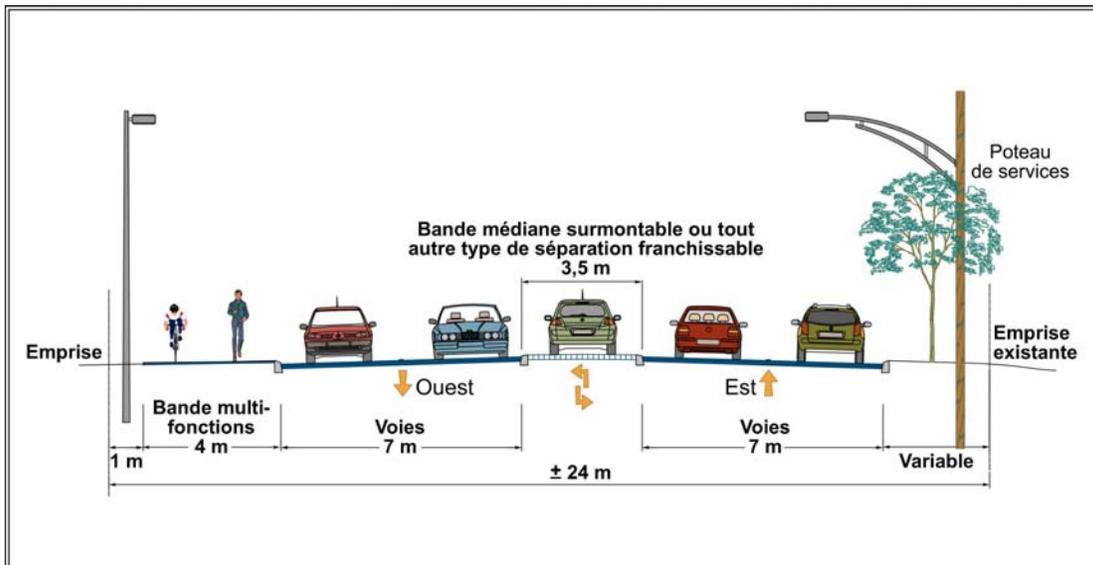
Coupe type du futur boulevard de la Cité des Jeunes – Traversée ferroviaire
